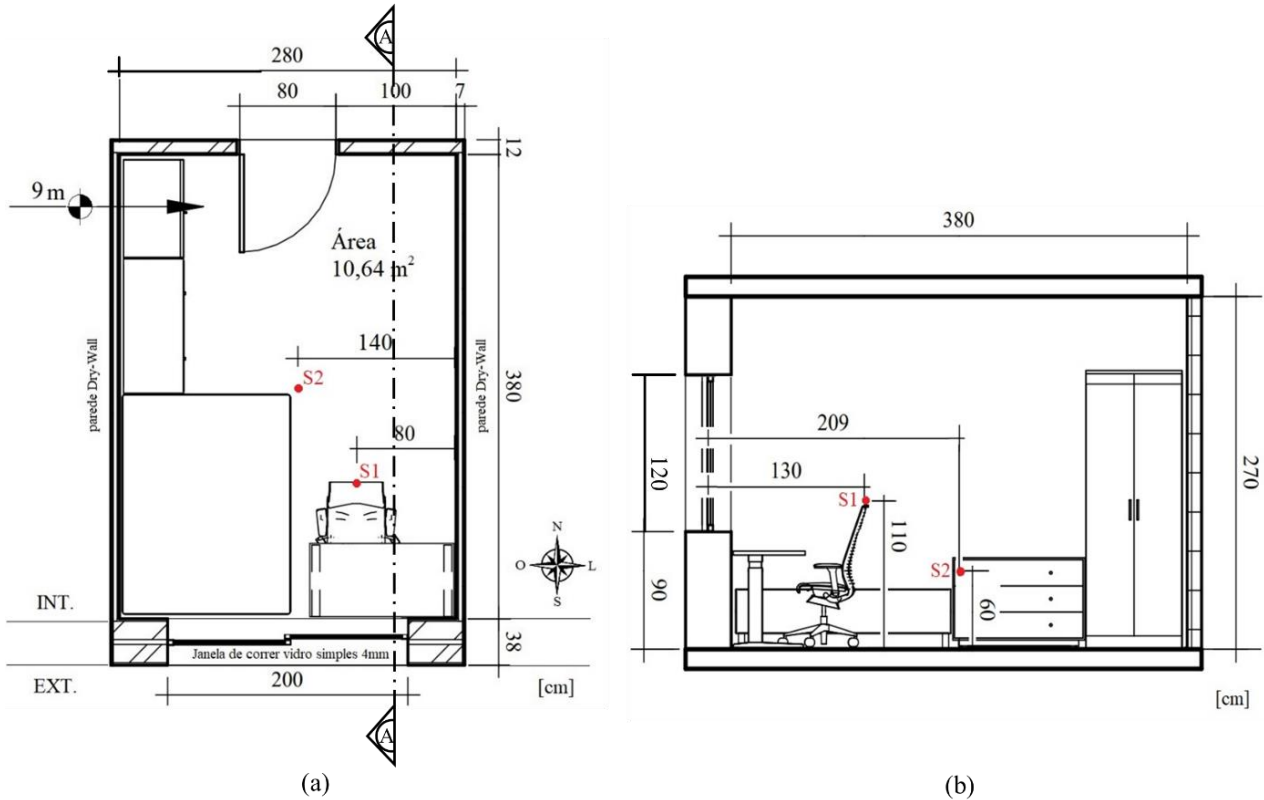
(a) Planta baixa do cômodo (b) Corte AA
